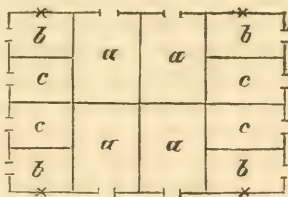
gibt den Grundriß eines ähnlichen Gebäudes:
